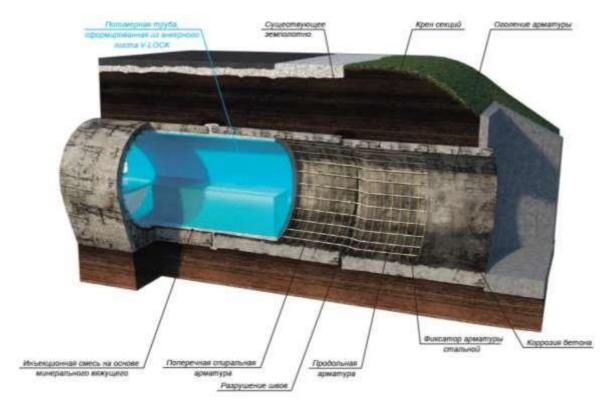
ИМ ремонтируемой водопропускной круглой железобетонной трубы, d=1.5м
